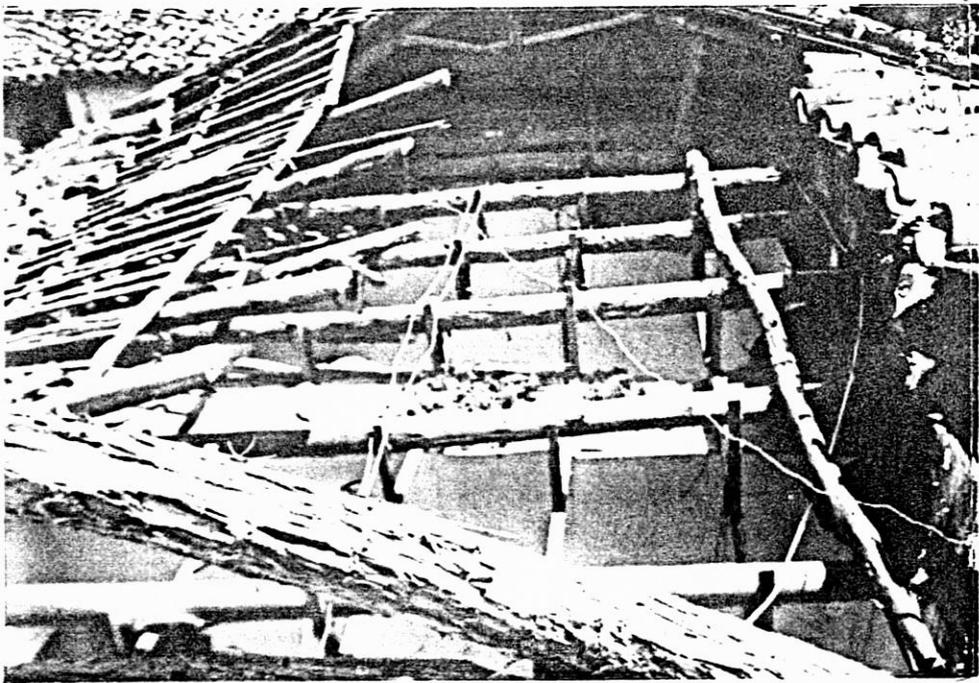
Daños causados por termites en madera estructural (Ancuya)
